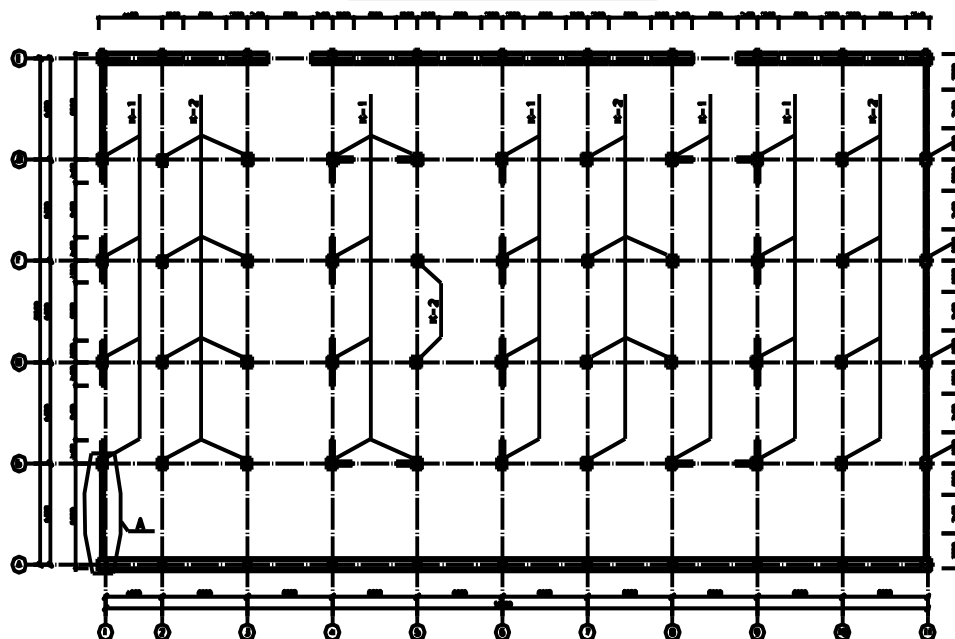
Схема усиления колонн, ригелей и стен цокольного этажа здания
